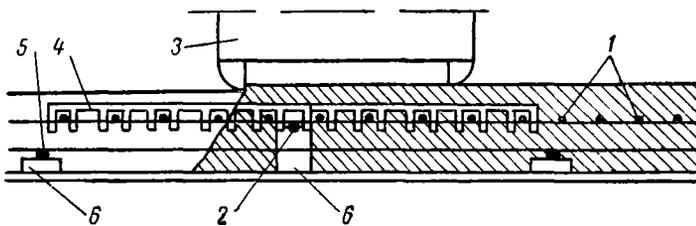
Схема раскладки арматурных стержней и установка переносных гребенок при использовании бетоноукладочной машины типа Д-375:
